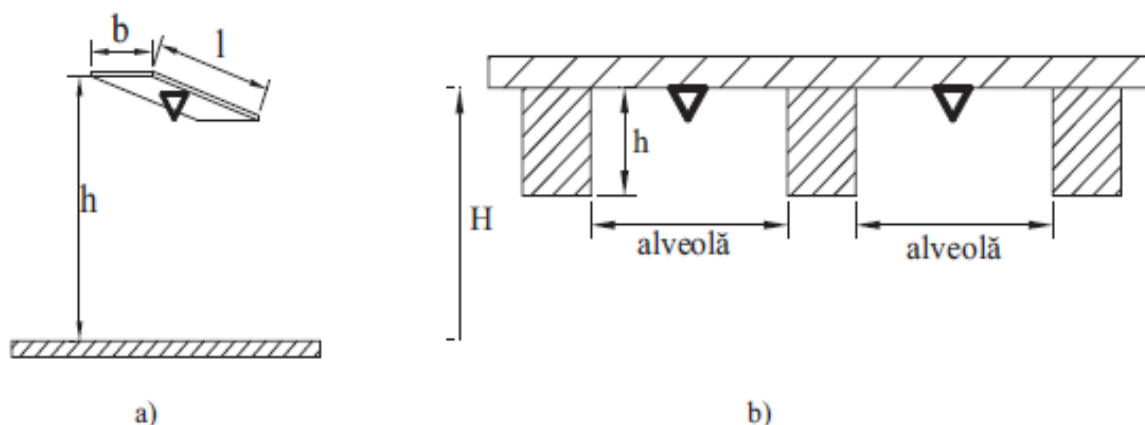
Amplasarea detectoarelor: a) sub tavan în prezența platformelor, cutiilor, etc.; b) sub tavan cu elemente de construcție proeminente.
